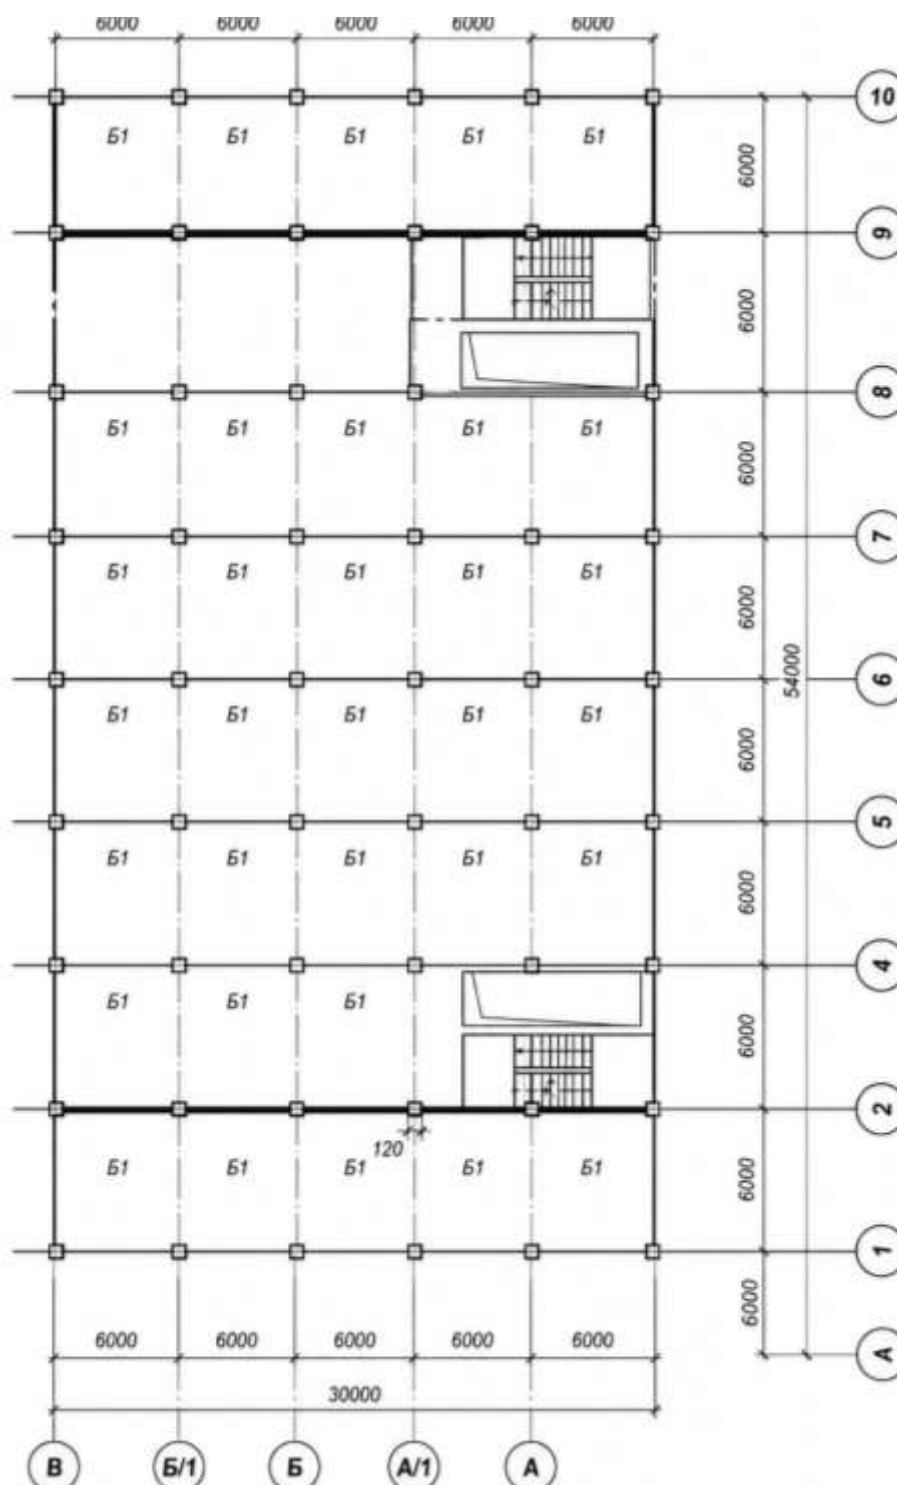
План типового поверху промислової будівлі до реконструкції
